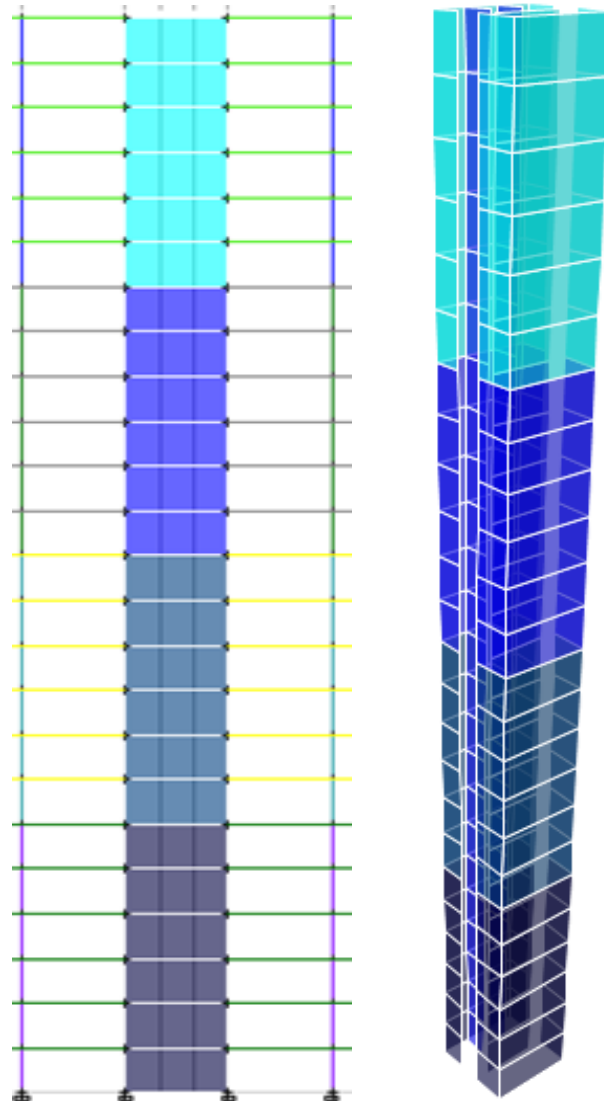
9: Vista en Elevación y 3D de la Caja escalera y ascensor, edificio tipo B.
